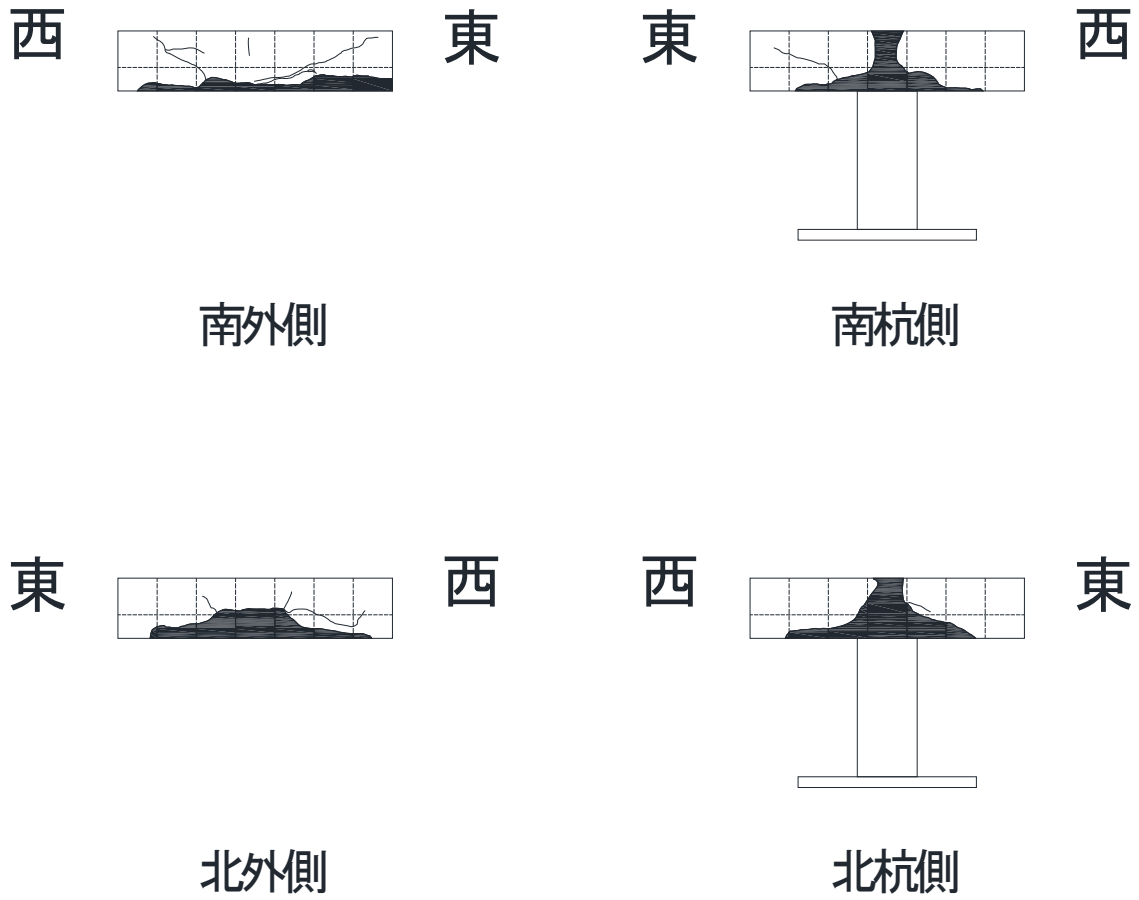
2. 4-38 試験体 DR-5 切断面ひび割れ
